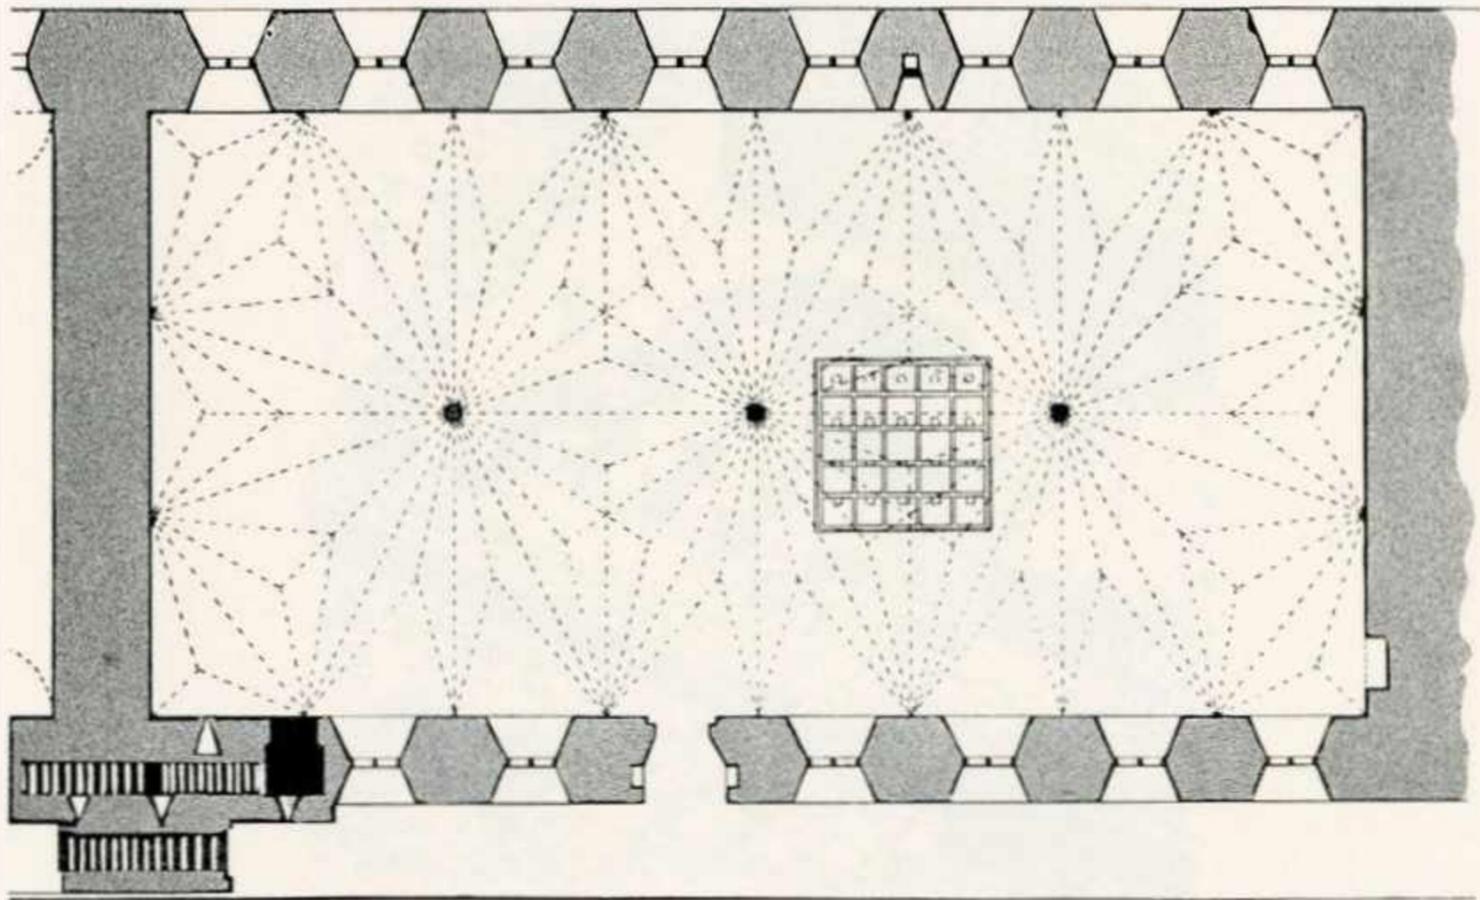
La grande salle des chevaliers, le «remter», de Marienburg sur la Nogat était tempérée au moyen d'un chauffage à air chaud, construit en 1325, dont les bouches à chaleur, pratiquées dans le plancher, sont nettement visibles sur le plan. (Texte, page 37.)
